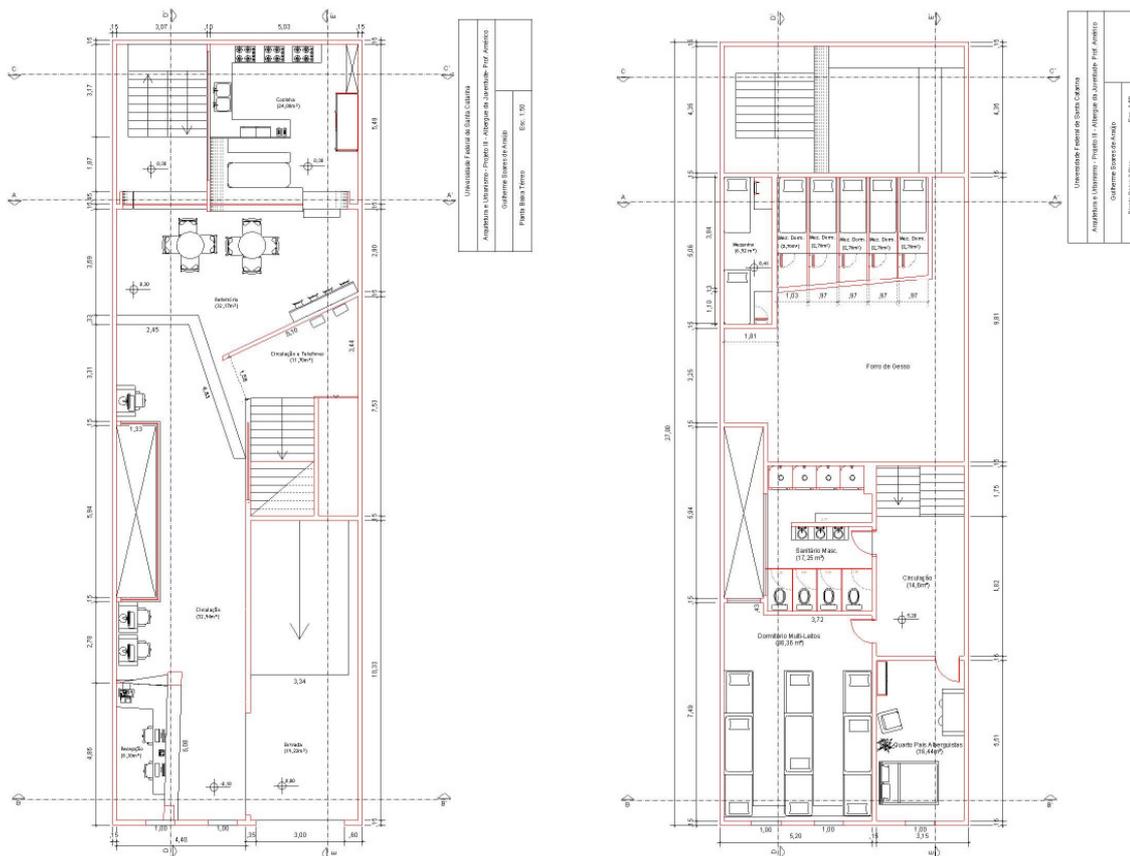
Plantas baixas do pvtto. térreo e do 3^o pvtto. do aluno Guilherme.
